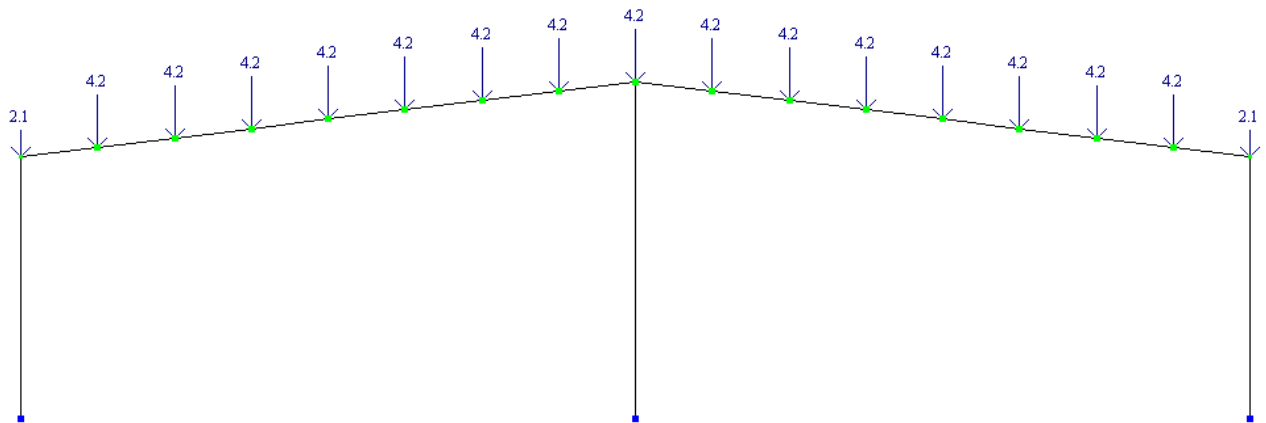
Схема загрузки поперечной рамы снеговой нагрузкой
